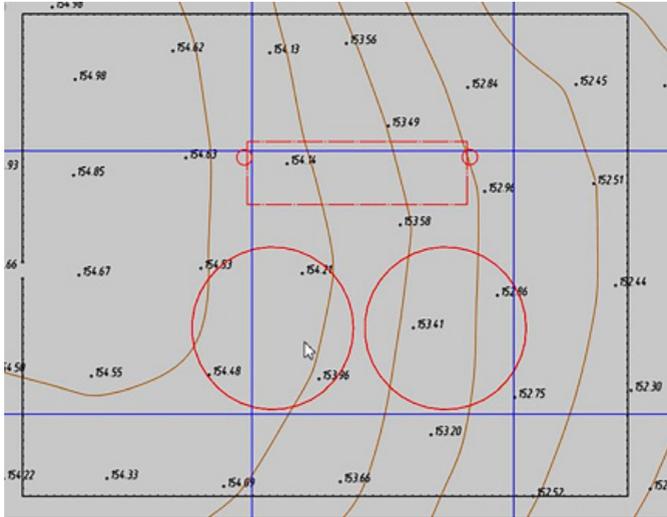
Чертеж, подготовленный для отрисовки контура здания
